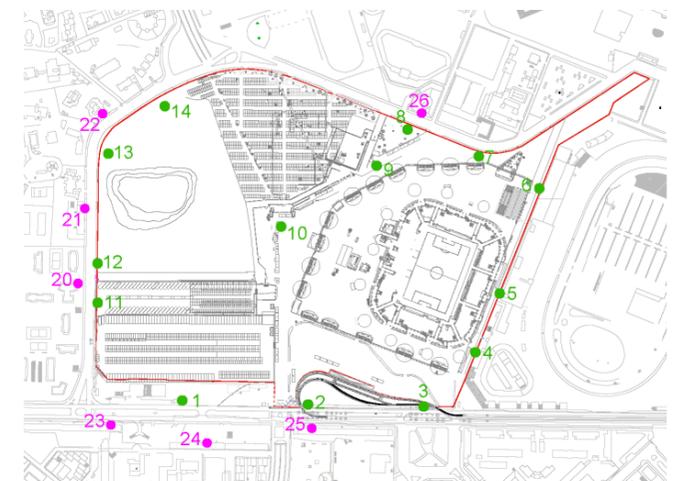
Posizioni dei ricettori, sovrapposte alla planimetria dello stato di fatto
